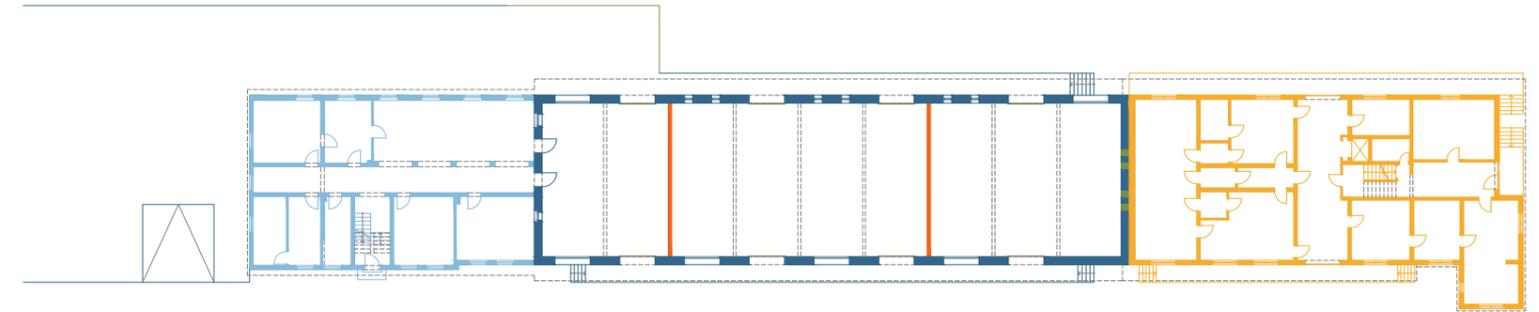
Baualtersplan: Zollamt und Zollschuppen, Erdgeschoss 2022 M 1:500
